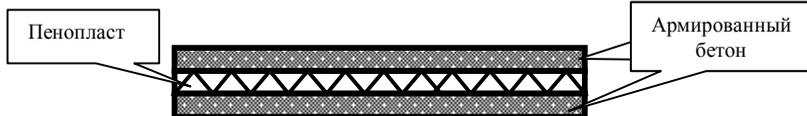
Конструкция железобетонных плит, обследованных георадарным методом
